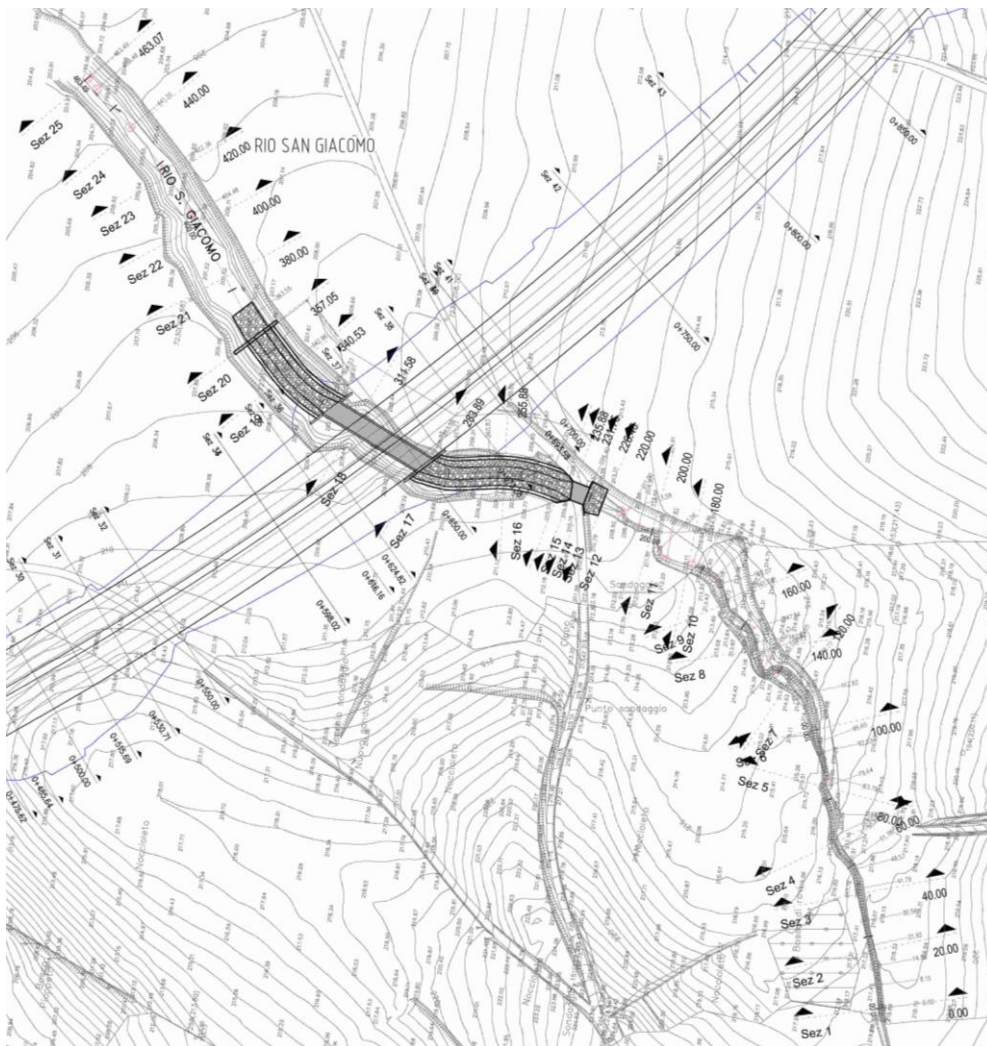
Planimetria del tratto oggetto di analisi idraulica
